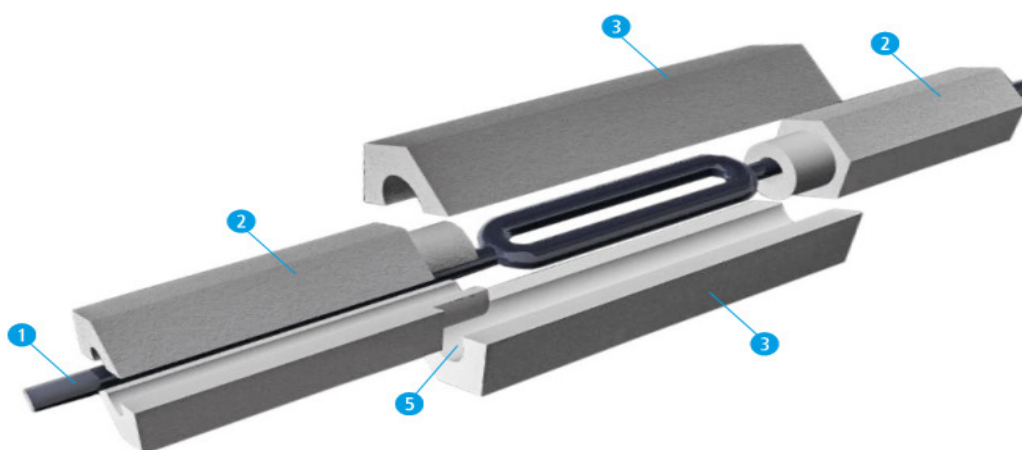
Schema protezione tirante in acciaio tramite coppella
